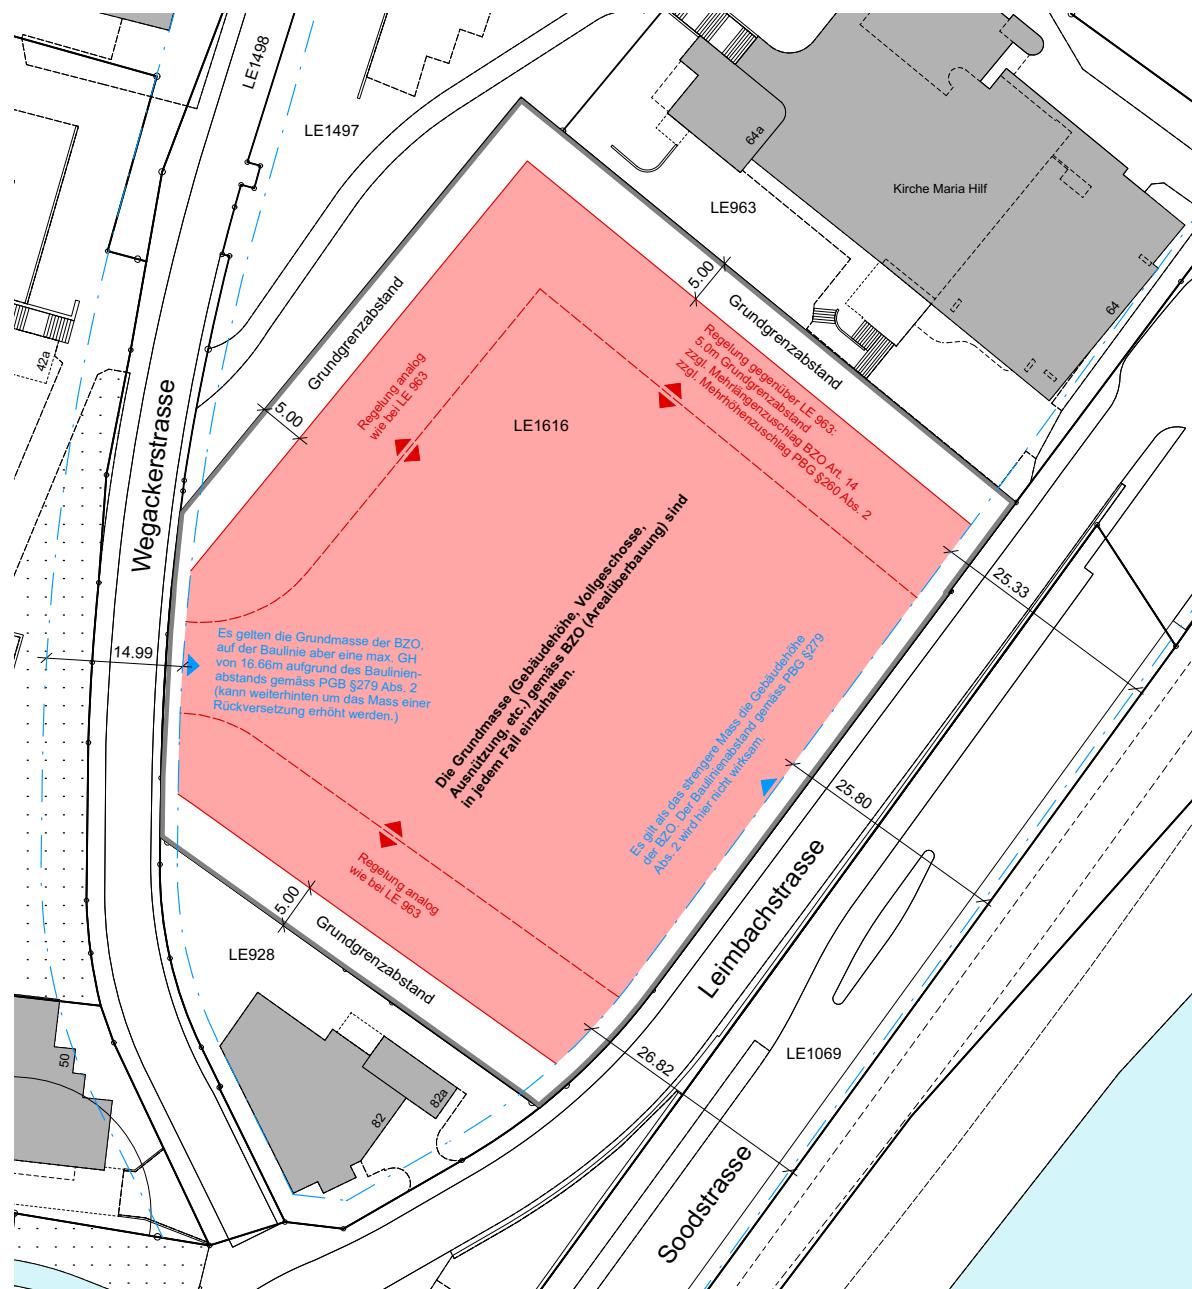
Schemaplan Baurecht (abstrahierte, vereinfachte Darstellung des Baurechtsregimes)
